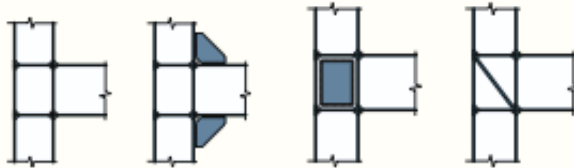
Refuerzos metálicos de viga-columna (Fuente: Mazzolani, 2008)
